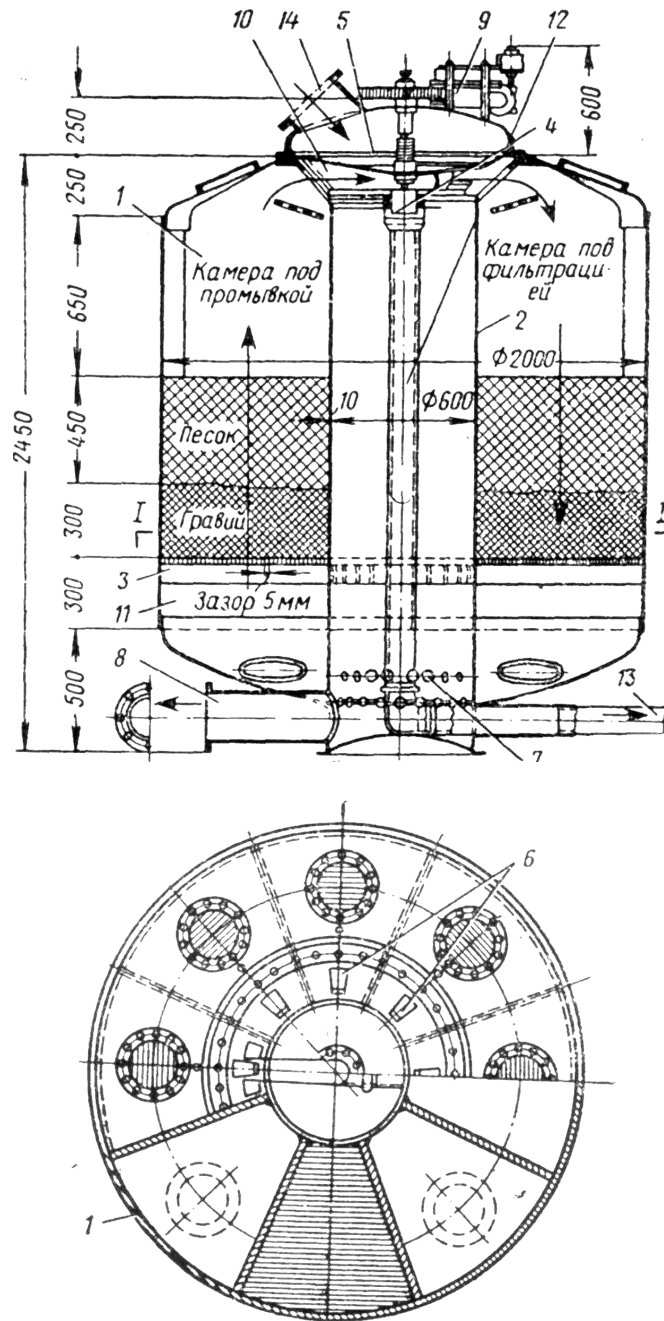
Напорный сверхскоростной фильтр камерного типа: 1 – цилиндрический резервуар; 2 – цилиндрическая шахта; 3 – кольцевое дырчатое дно; 4 – подача осветляемой воды; 5 – распределительная камера; 6 – трапециевидные отверстия; 7 – отверстия для поступления воды из поддренажного пространства в шахту; 8 – подача воды потребителю; 9 – электродвигатель; 10 – патрубок; 11 – поддренажное пространство; 12 – трубопровод, соединенный с патрубком; 13 – спуск воды в канализацию; 14 – люк
